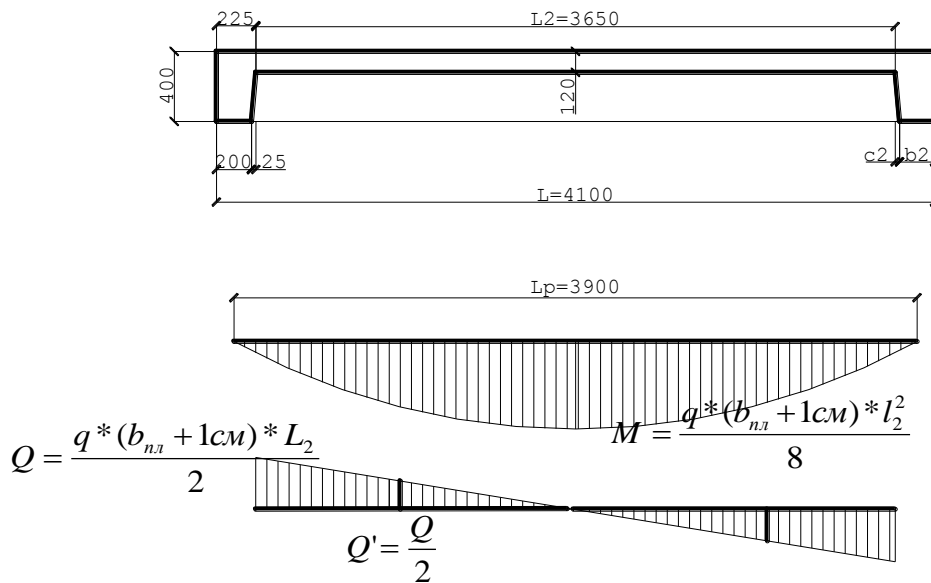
Расчетная схема и усилия в плите покрытия. Продольный разрез
